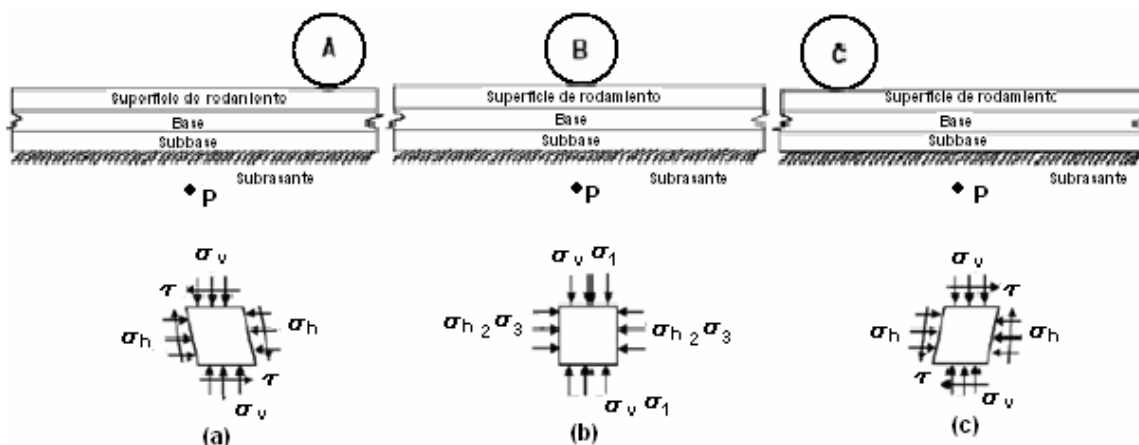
Estado de esfuerzos en una sección longitudinal de un pavimento
